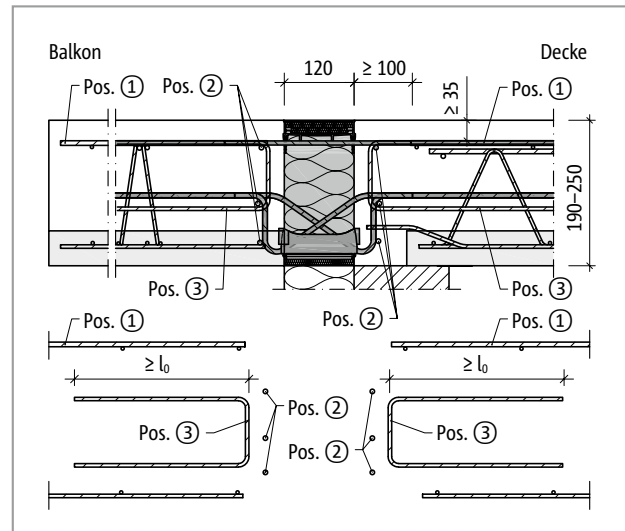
Schöck Isokorb® XT Typ K-F-VV: Bauseitige Bewehrung bei Balkonplattendicke  $h = 190\text{--}250\text{ mm}$
